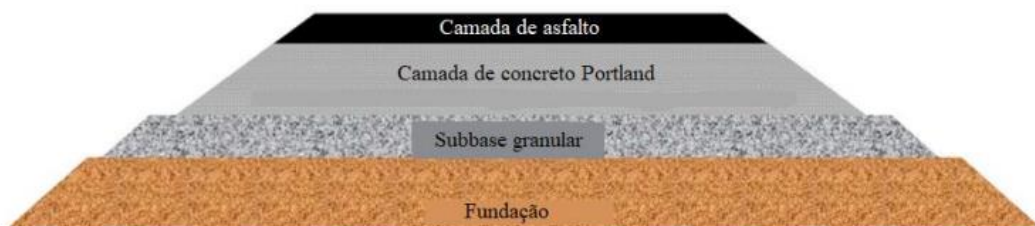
Seção transversal usual de um pavimento Semi-Rígido (Plati, 2019).
